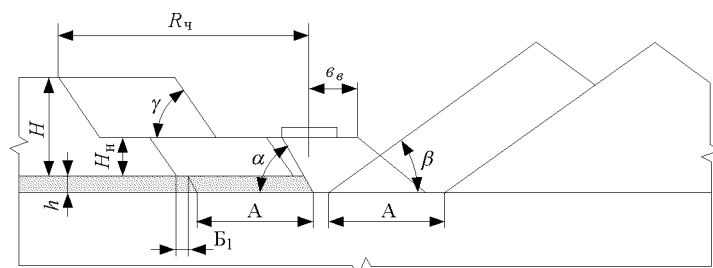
Схема перевалки вскрышных пород (без подвалки внутреннего отвала)
